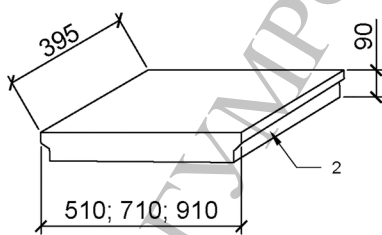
Варианты заполнения перекрытия между железобетонными балками:
